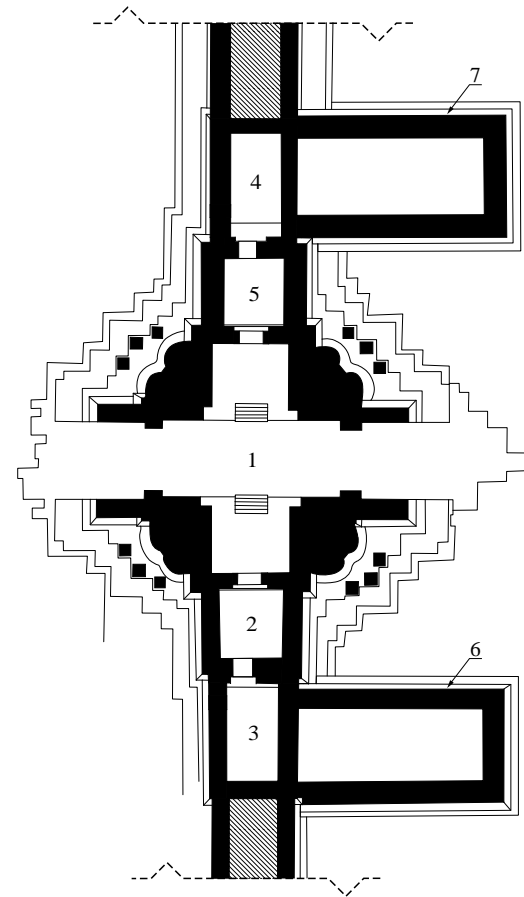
Plan de la porte des Morts d'Angkor
